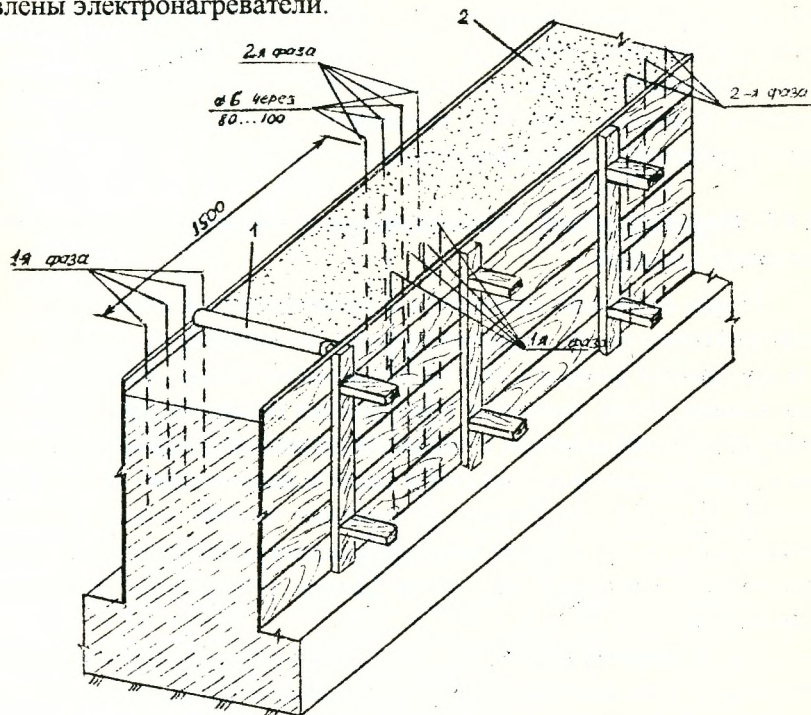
Электропрогрев бутобетонного фундамента (сетевое напряжение 120-220 В) при групповом расположении нашивных электродов.
